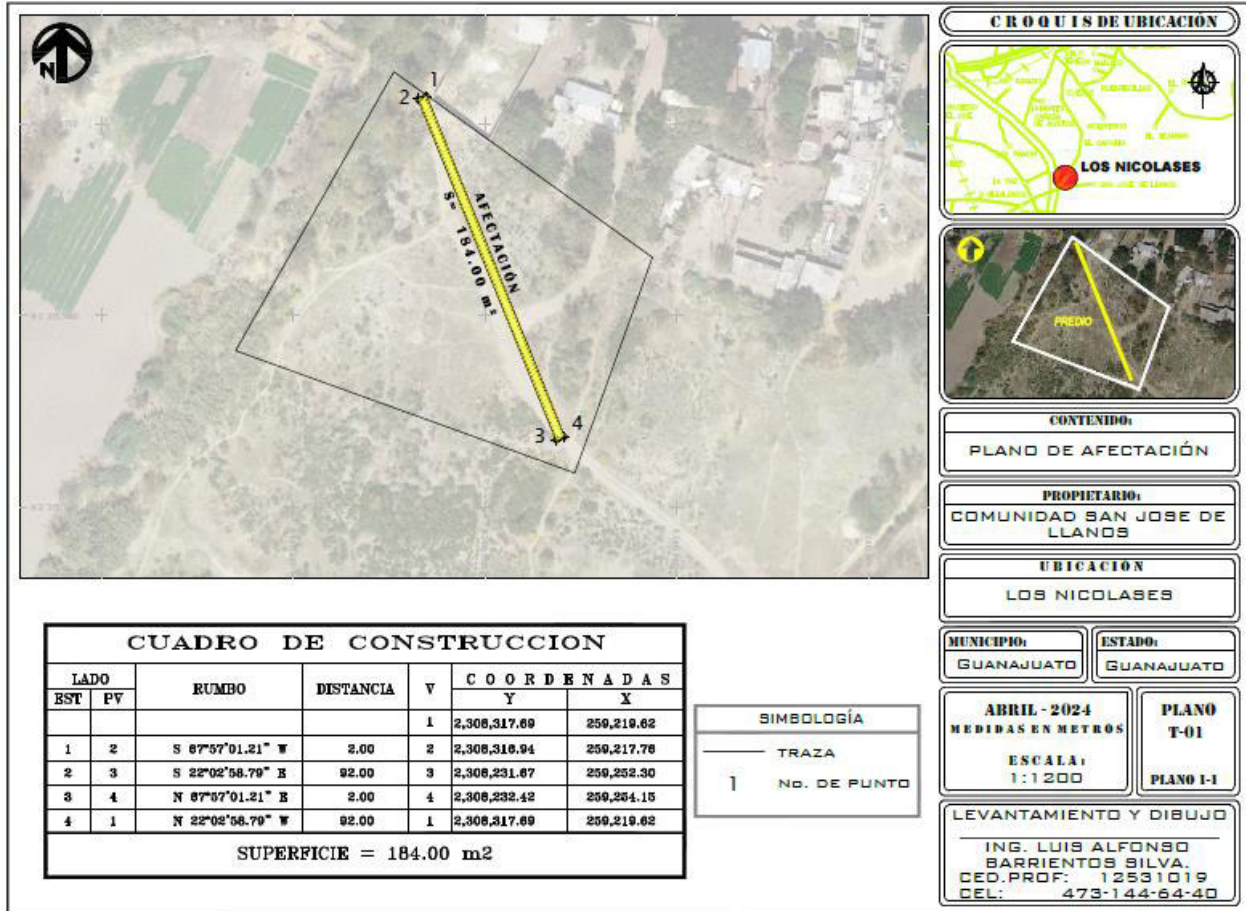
Plano topográfico de afectación. (Elaboración propia).
